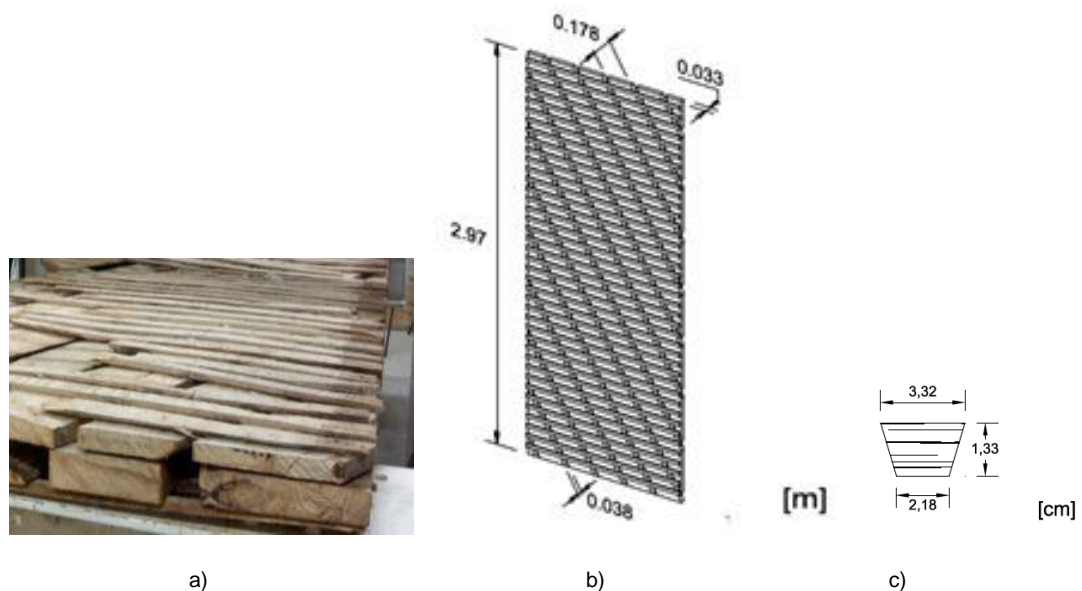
a) 3ª Parede de tabique recolhida para o ensaio – Parede de Tabique Duplo; b) Detalhe construtivo da parede de tabique; c) Detalhe construtivo das ripas com secção transversal trapezoidal [13]
